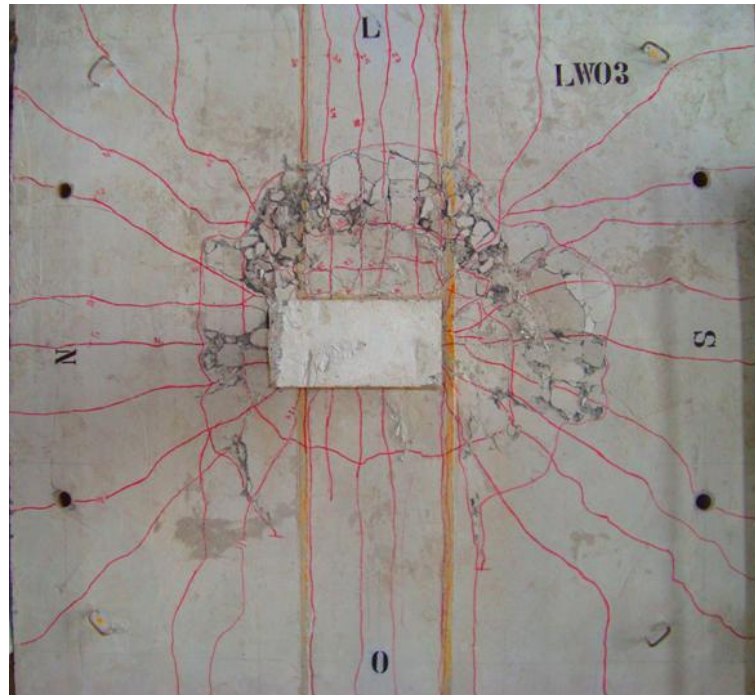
Padrão de fissuração do modelo LW03.
